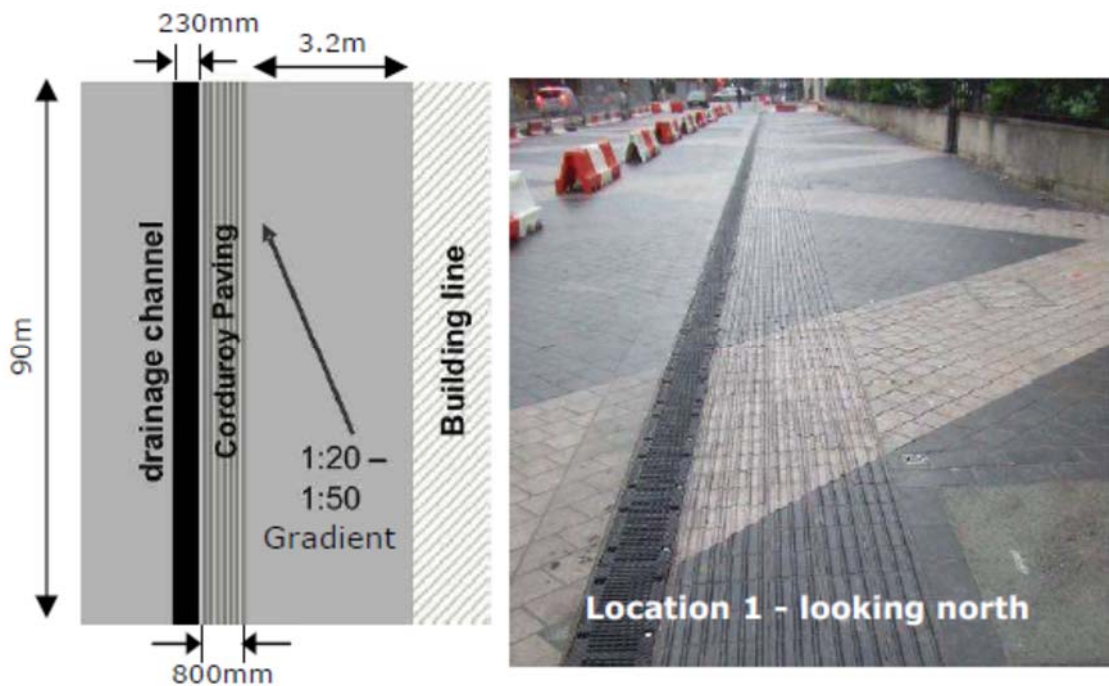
Características de la banda de encaminamiento analizada por MVA en Exhibition Road
